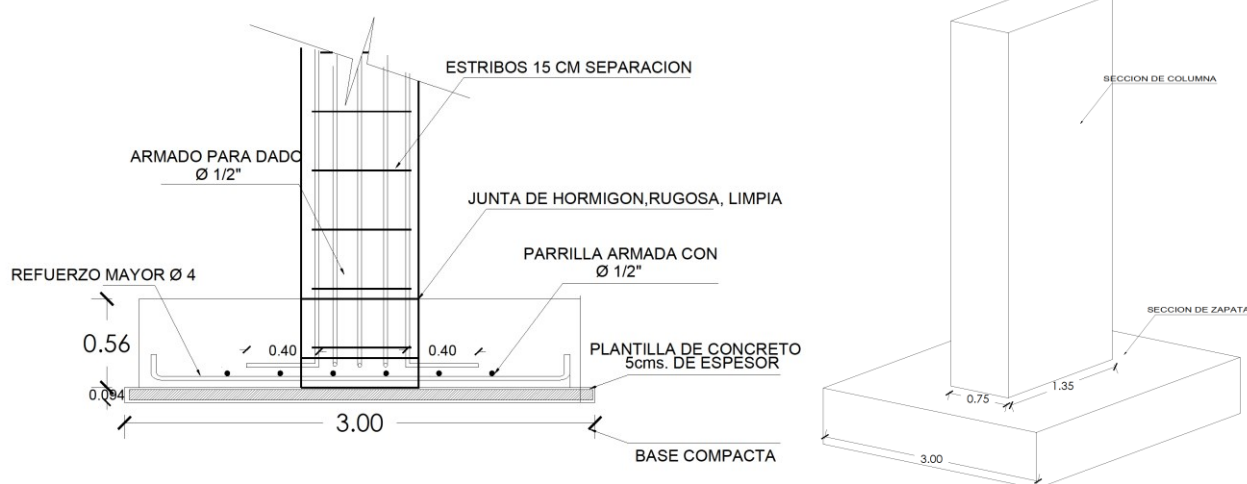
Detalle Zapatas/ Fuente Elaboracion Propia
